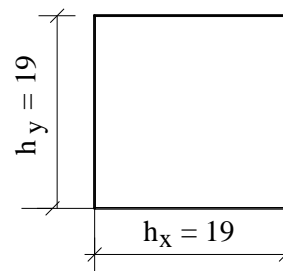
Dimensões (cm) da seção transversal do pilar P6.
